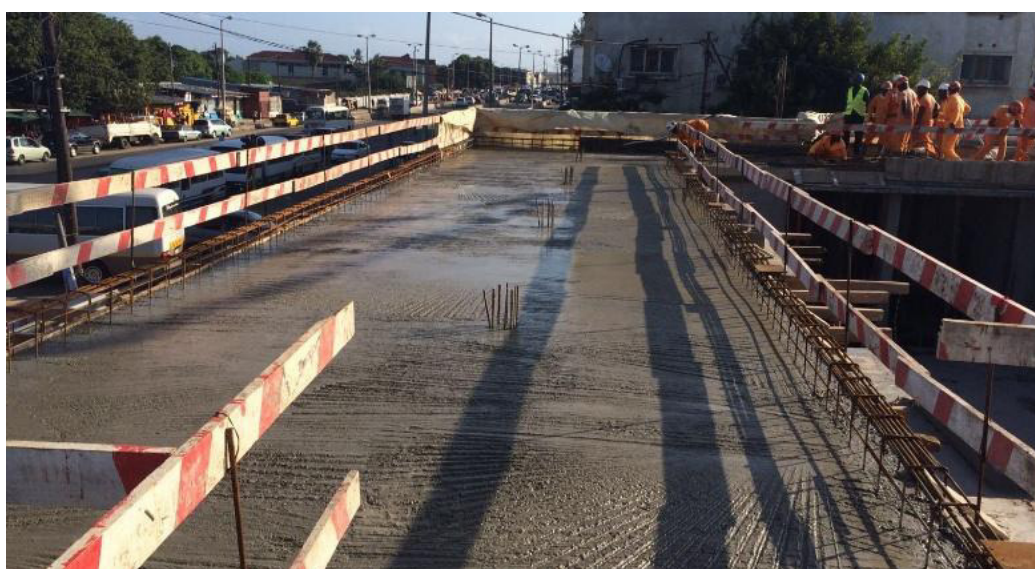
Betonagem da laje em consola zona do alpendre da agência
